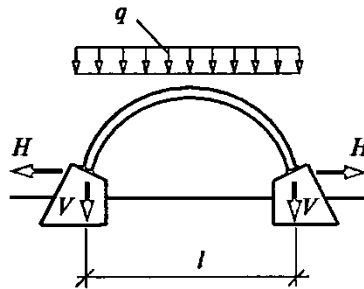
Передача нагрузки от арки на фундаменты:
